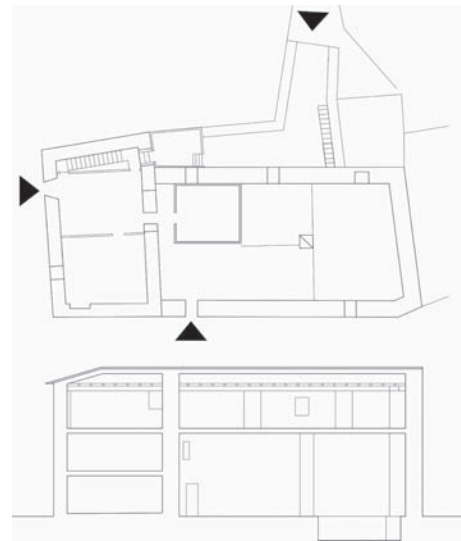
Planta y sección del estado inicial. (Autor: P. Díez).
